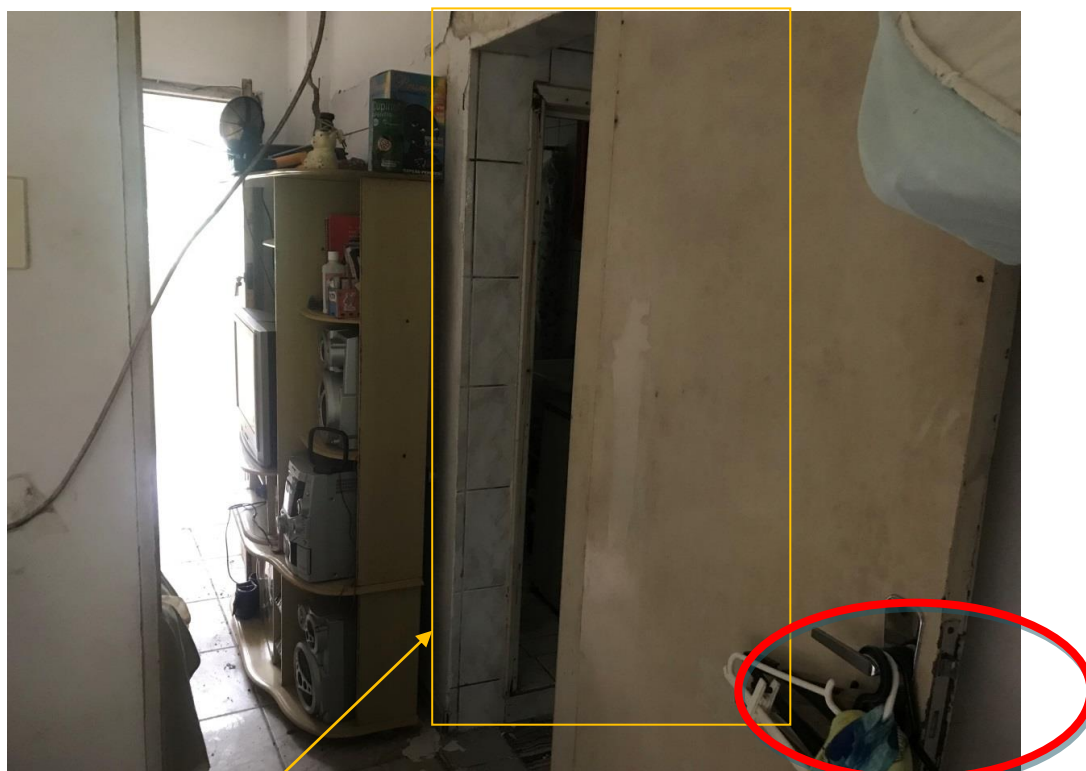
Vista do banheiro; há um tanque de louça ao invés do lavatório
